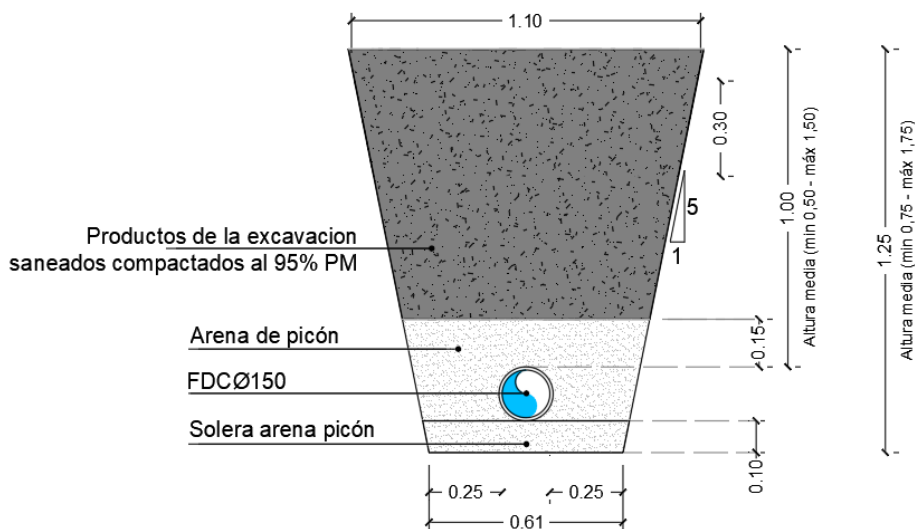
Figura VI. Sección tipo en tramo de terreno natural. Aducción o distribución.
